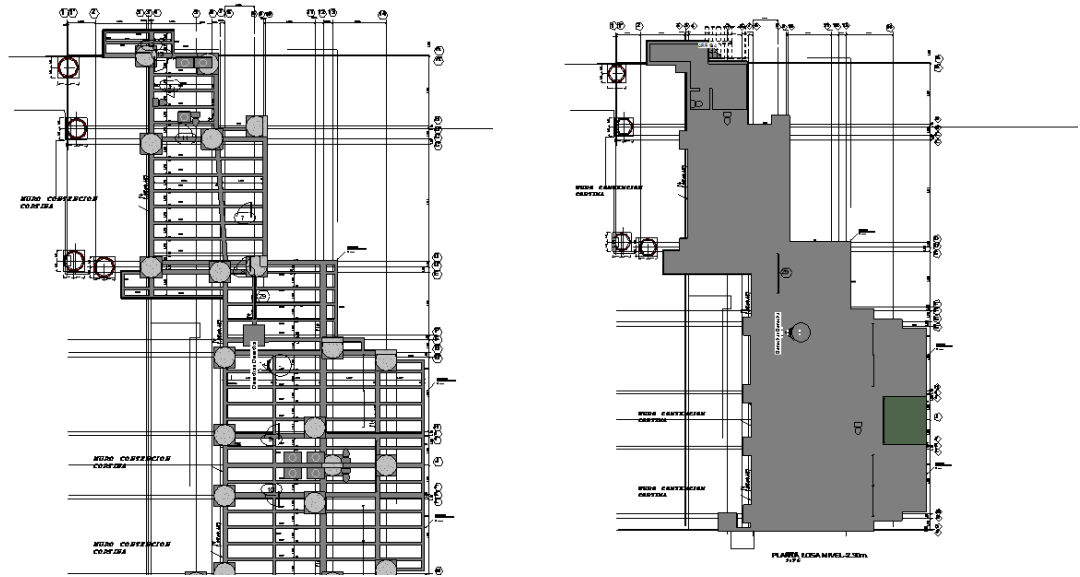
Creación de losa aligerada (vigas y recubrimiento) con la ayuda del plano de fundaciones
